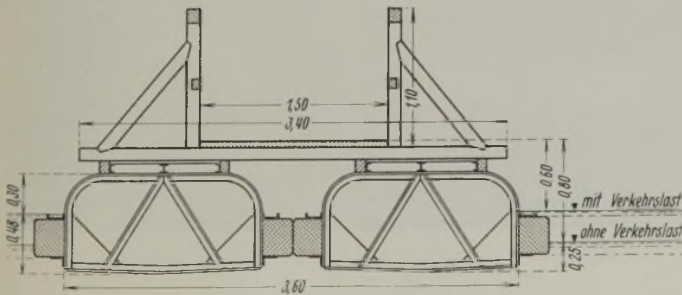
Querschnitt durch die Notbrücke in Abb. 17.
